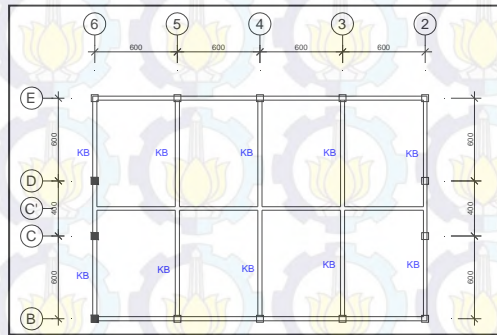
Perkuatan yang perlu dilakukan pada elemen struktur balok lantai 3 Gedung Bank Papua cabang Manokwari
